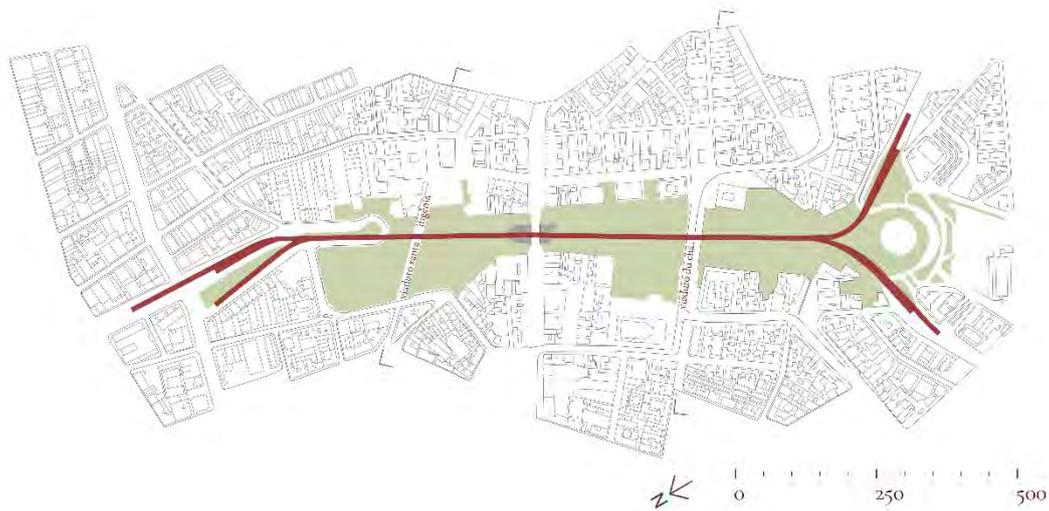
Anhangabaú Tobogán, plan general. Redibujo de Laura Betina Atuatti.
